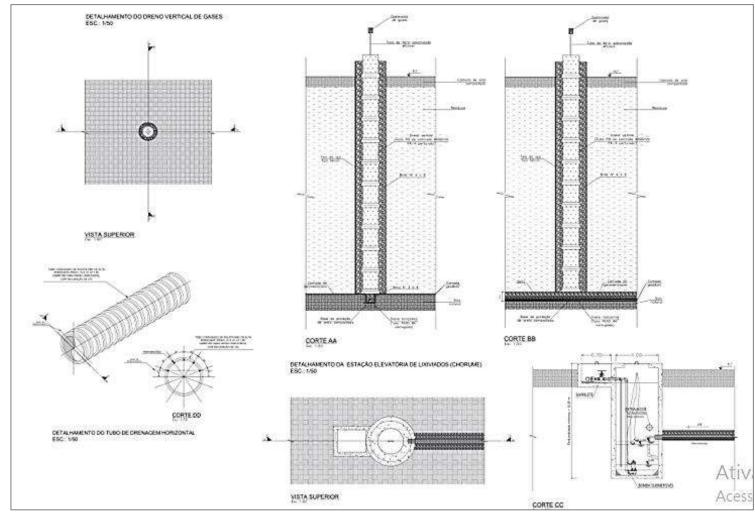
Cortes e detalhamento dos componentes do sistema de drenagem
